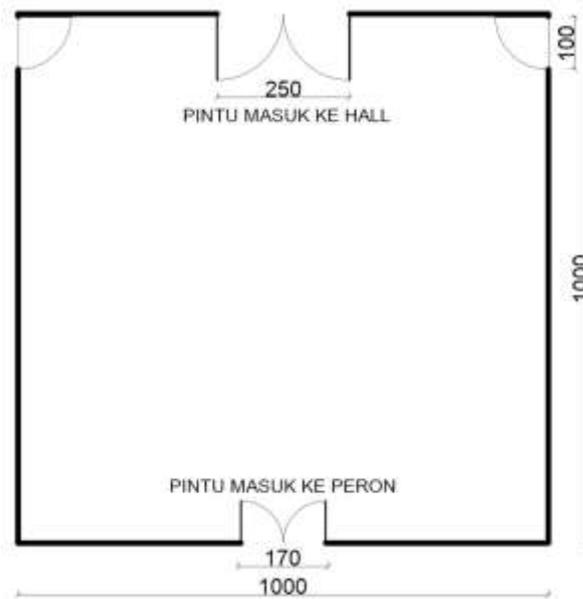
Contoh Ruang Istirahat Pekerja
